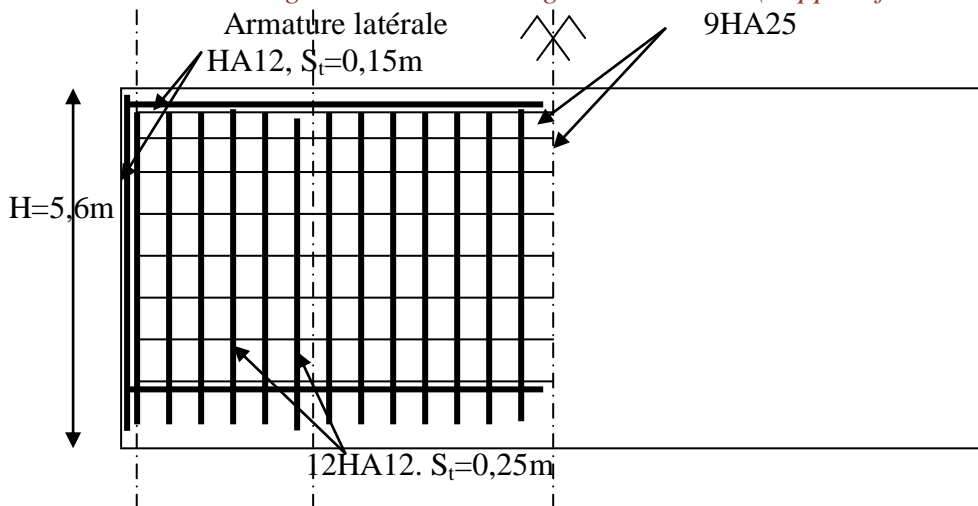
Ferrailage de la semelle (nappe supérieure)
